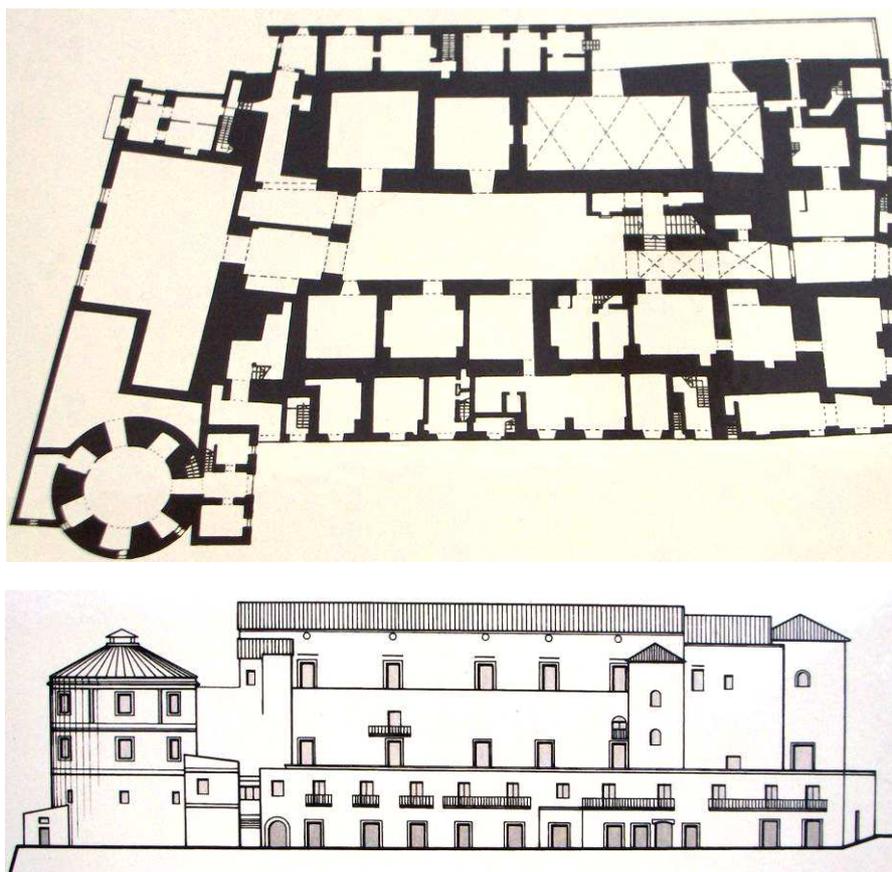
Sant'Agata dei Goti, pianta e prospetto principale del palazzo ducale.
